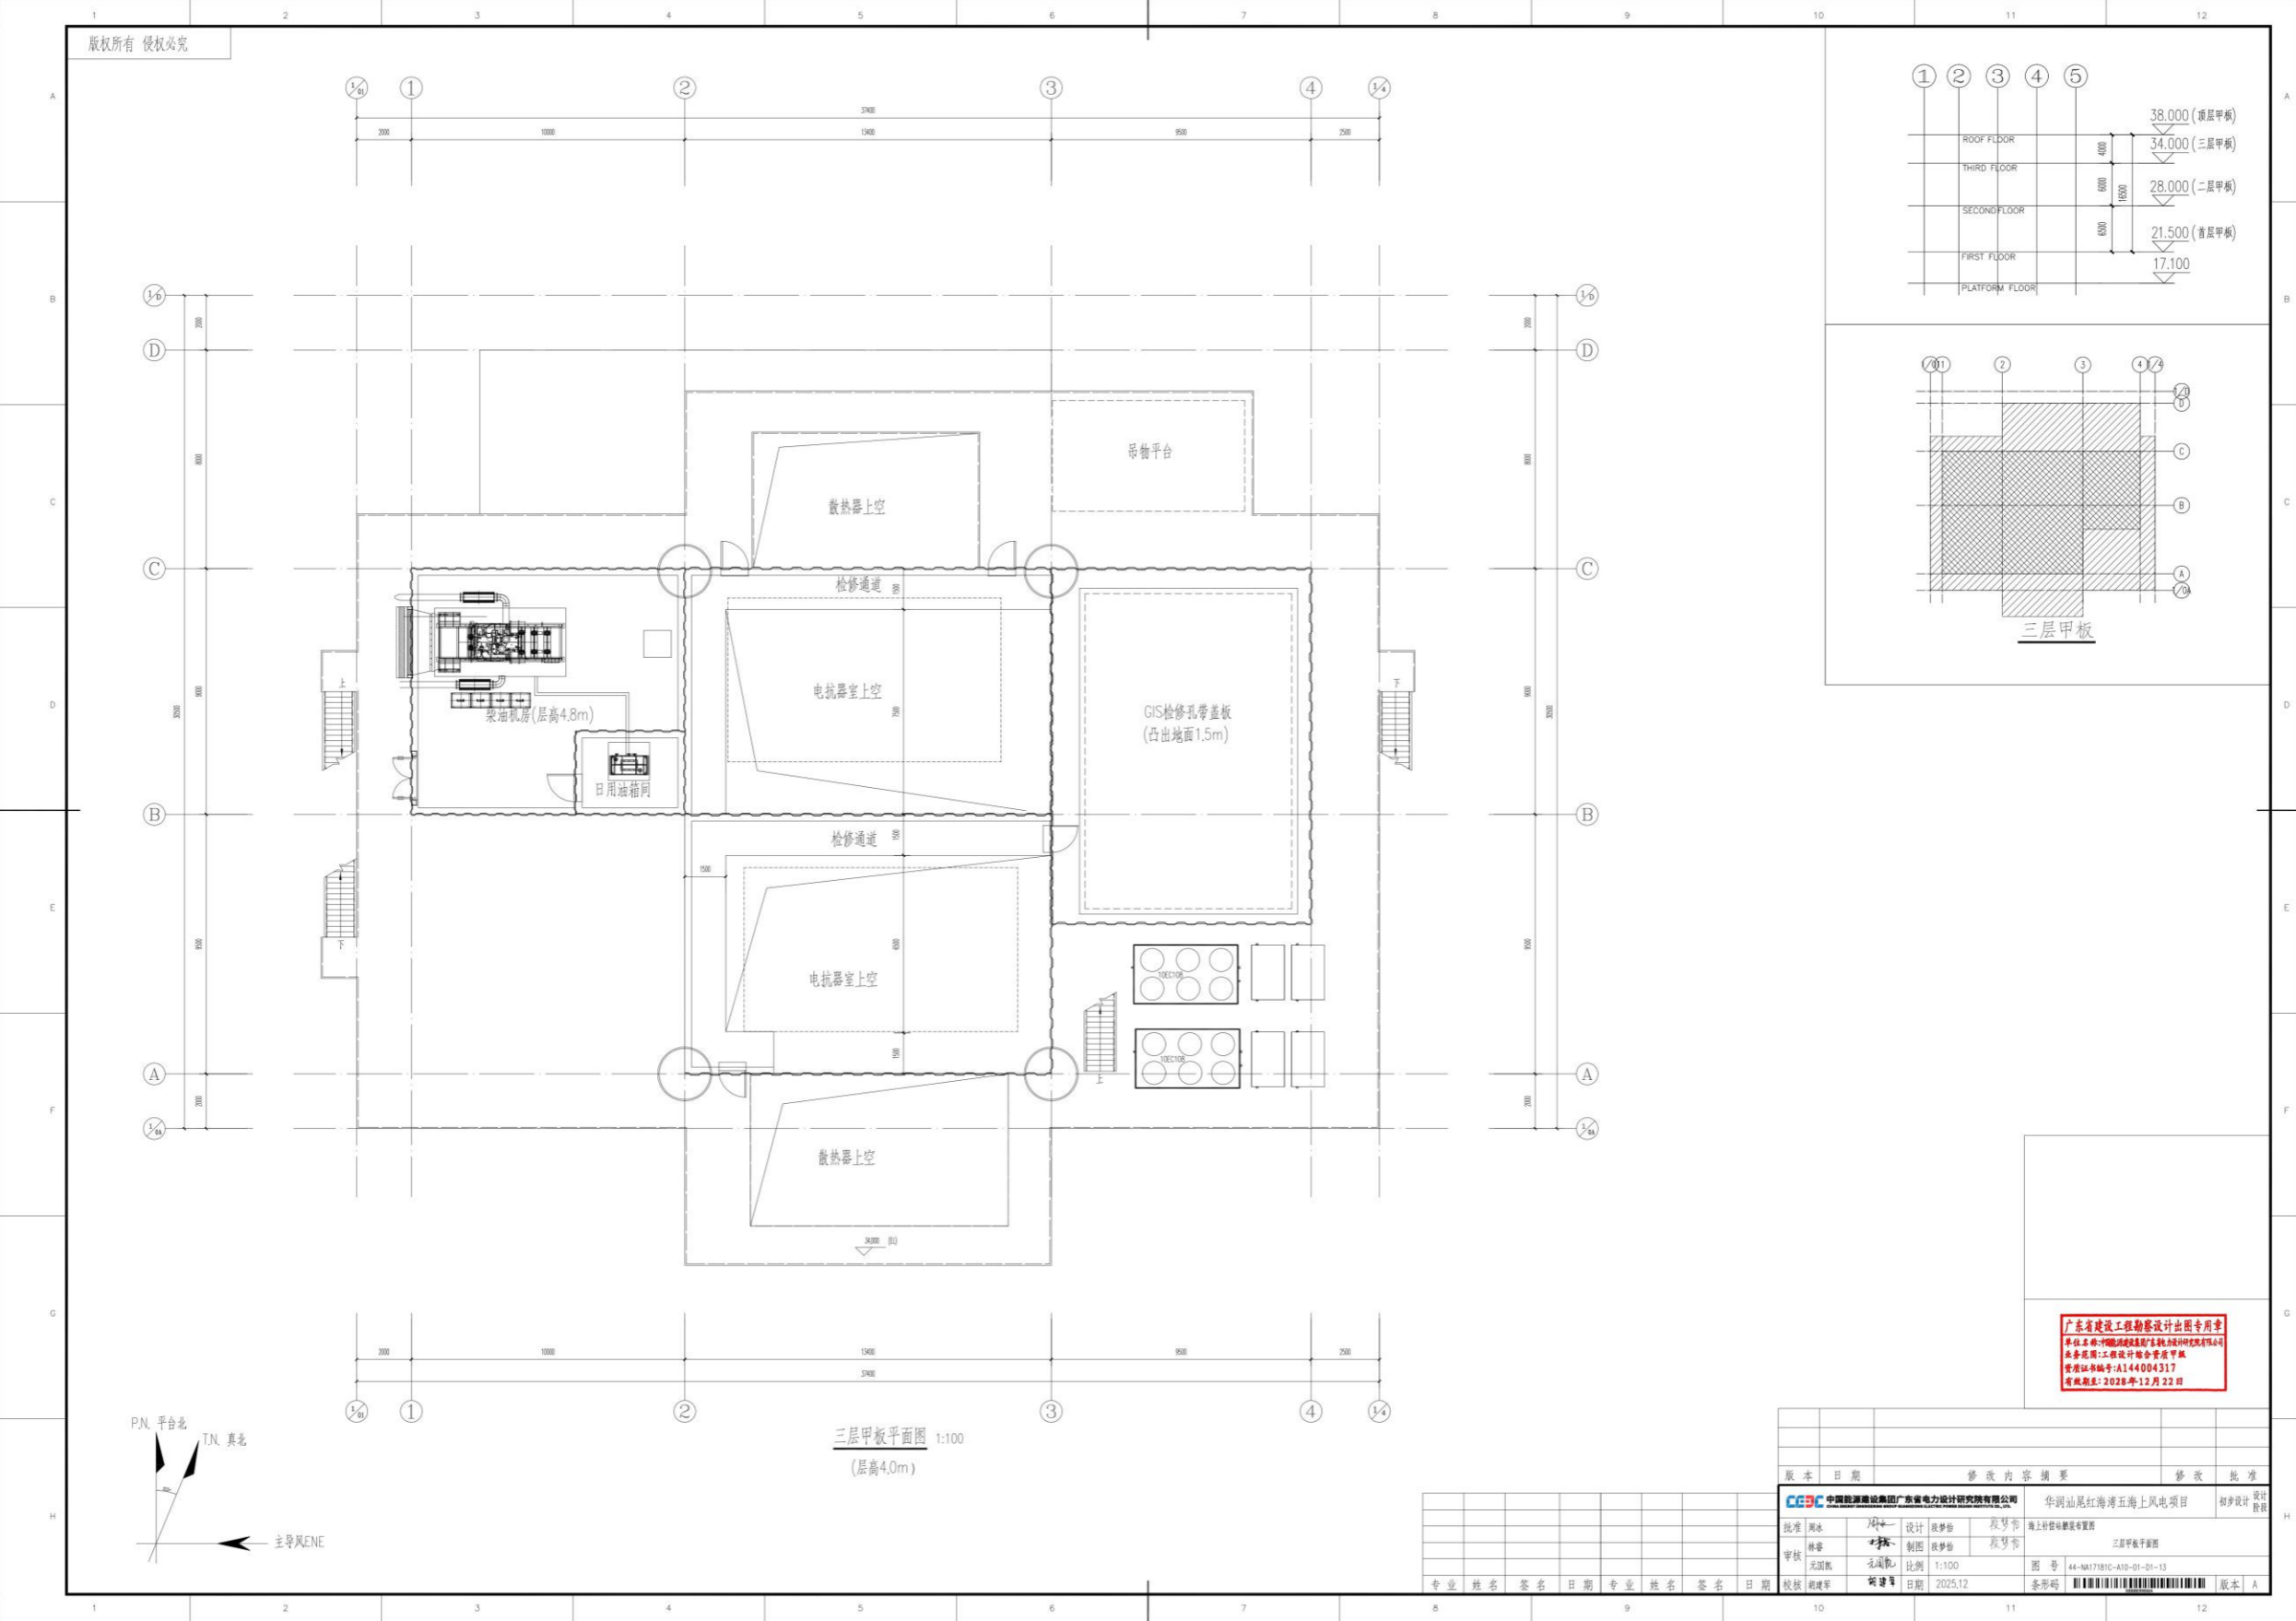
海上无功补偿站结构平面图（三层）
